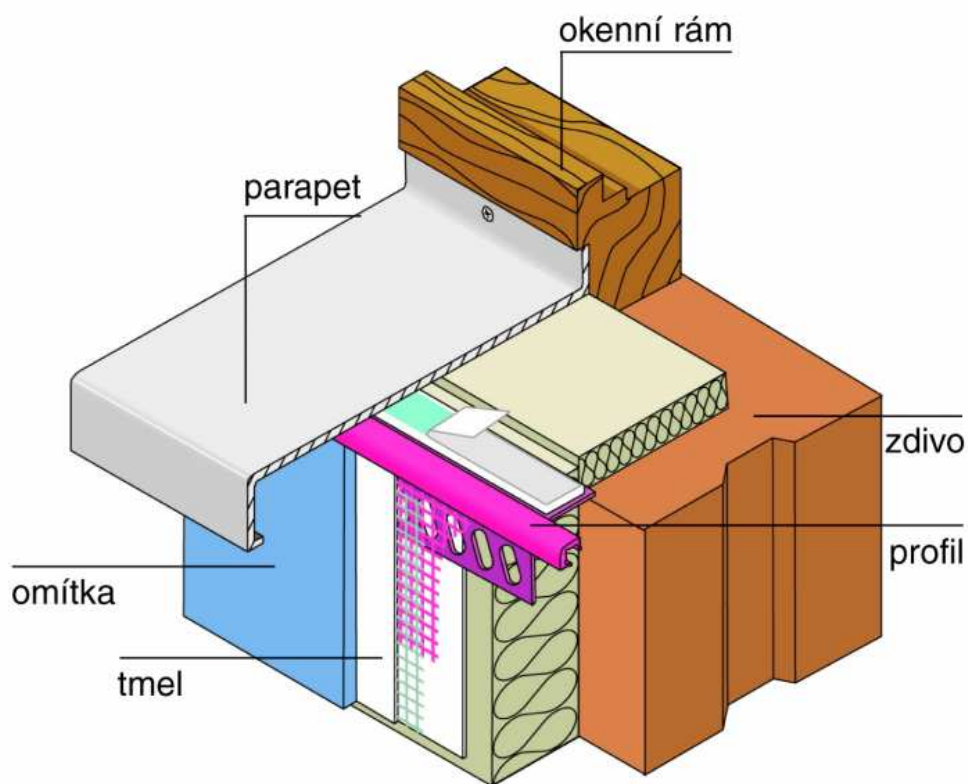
Detail - zakončovací profil s okapnicí a tkaninou
